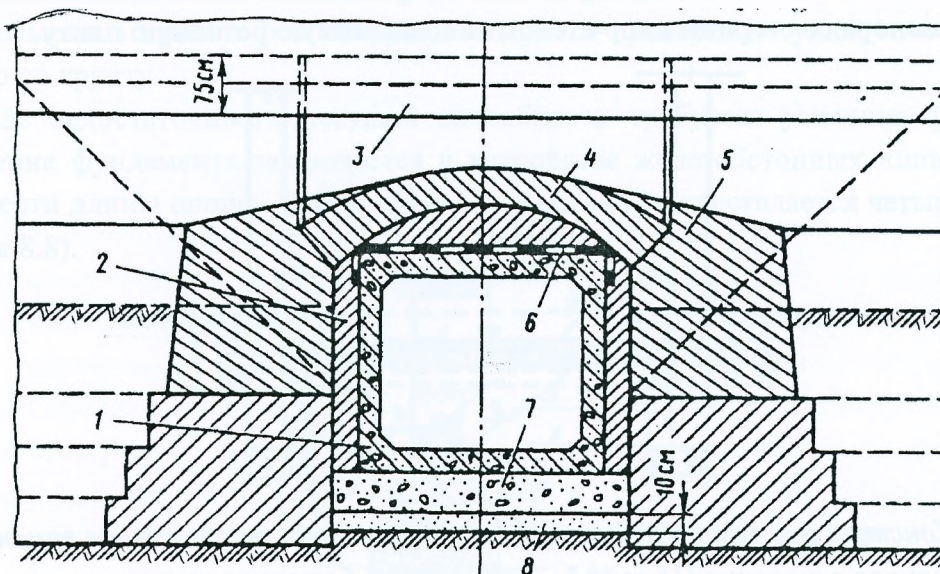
Переустройство каменного моста в трубу: 1 – прямоугольная железобетонная труба; 2 – бетон; 3 – щековые стенки моста, разбираемые на высоту 75 см; 4 – свод переустраиваемого моста; 5 – каменная кладка; 6 – гидроизоляция трубы; 7 – фундамент трубы; 8 – щебень.
